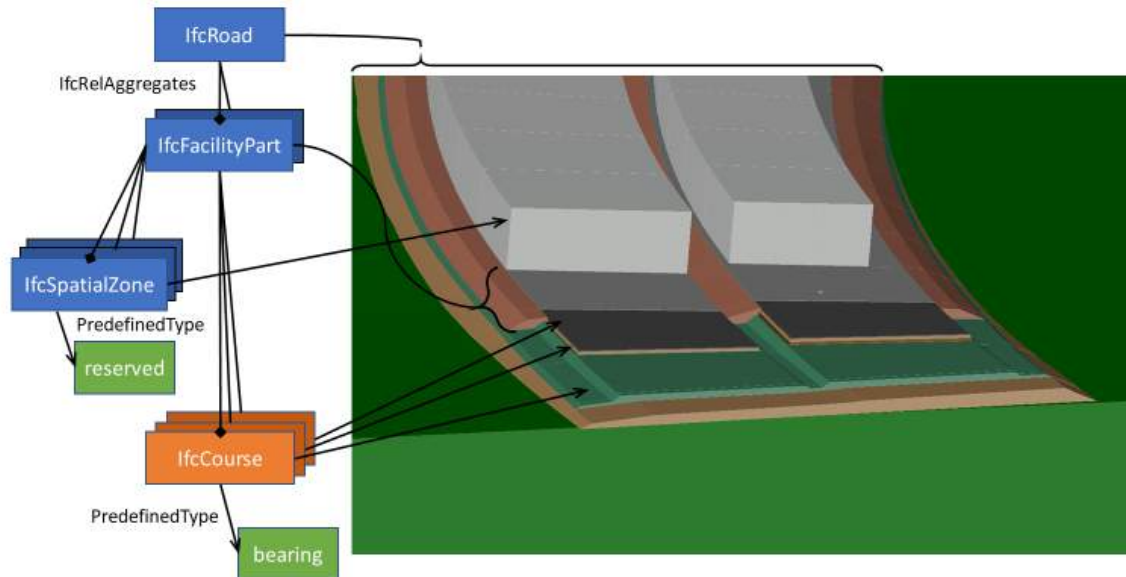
Aufbau einer Straße mit Klasse aus dem IFC-Road Standard
